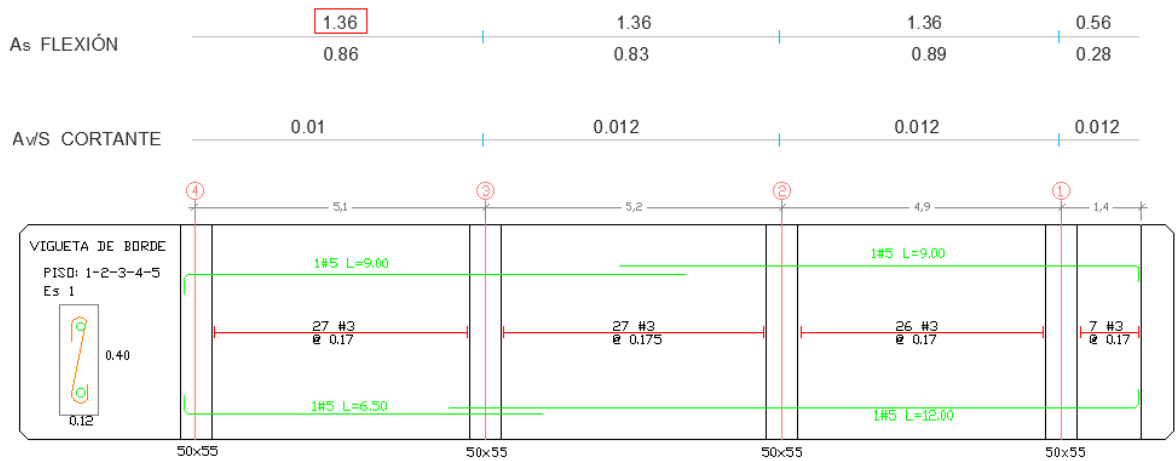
Cuantías obtenidas por esfuerzo a flexión, cortante y despiece de la vigueta de borde de la planta estructural. Fuente: elaboración propia.
